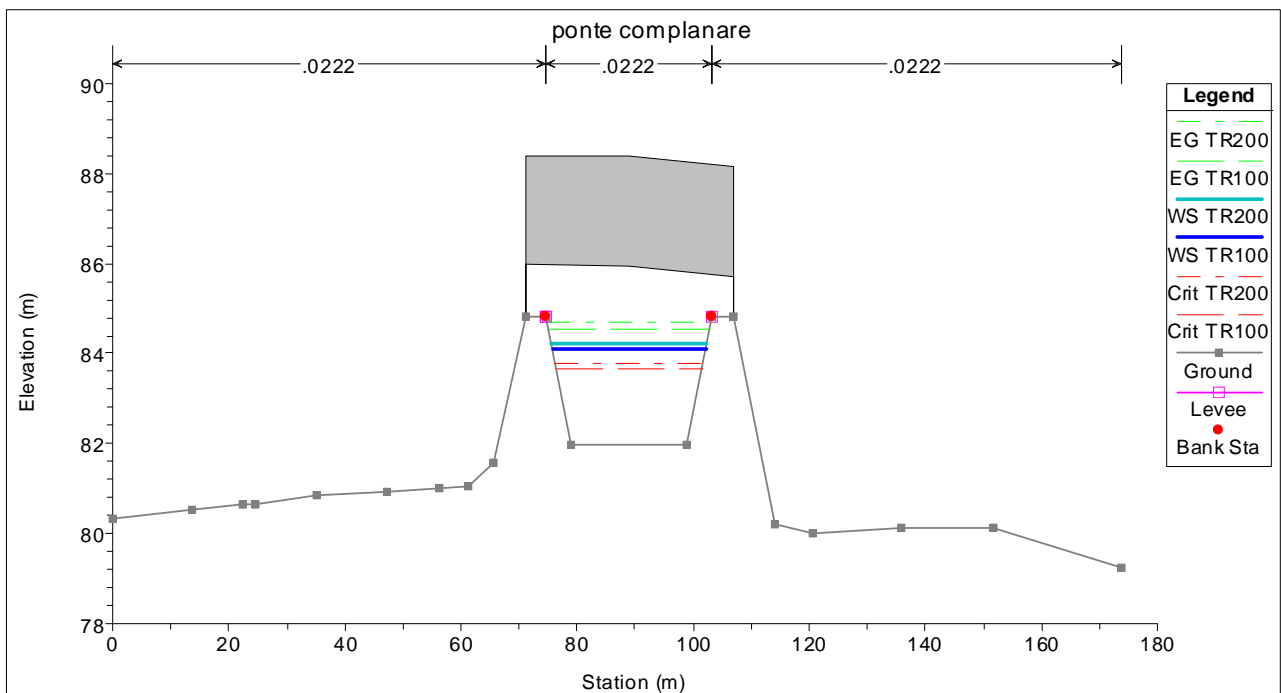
ponte sulla complanare in progetto - sezione di valle
